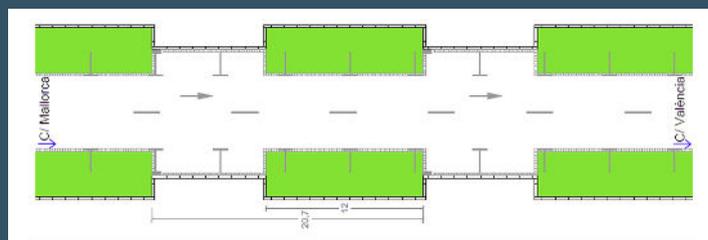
Planta de la propuesta para la C/ Lepanto, caso c) (Tipo 2).
